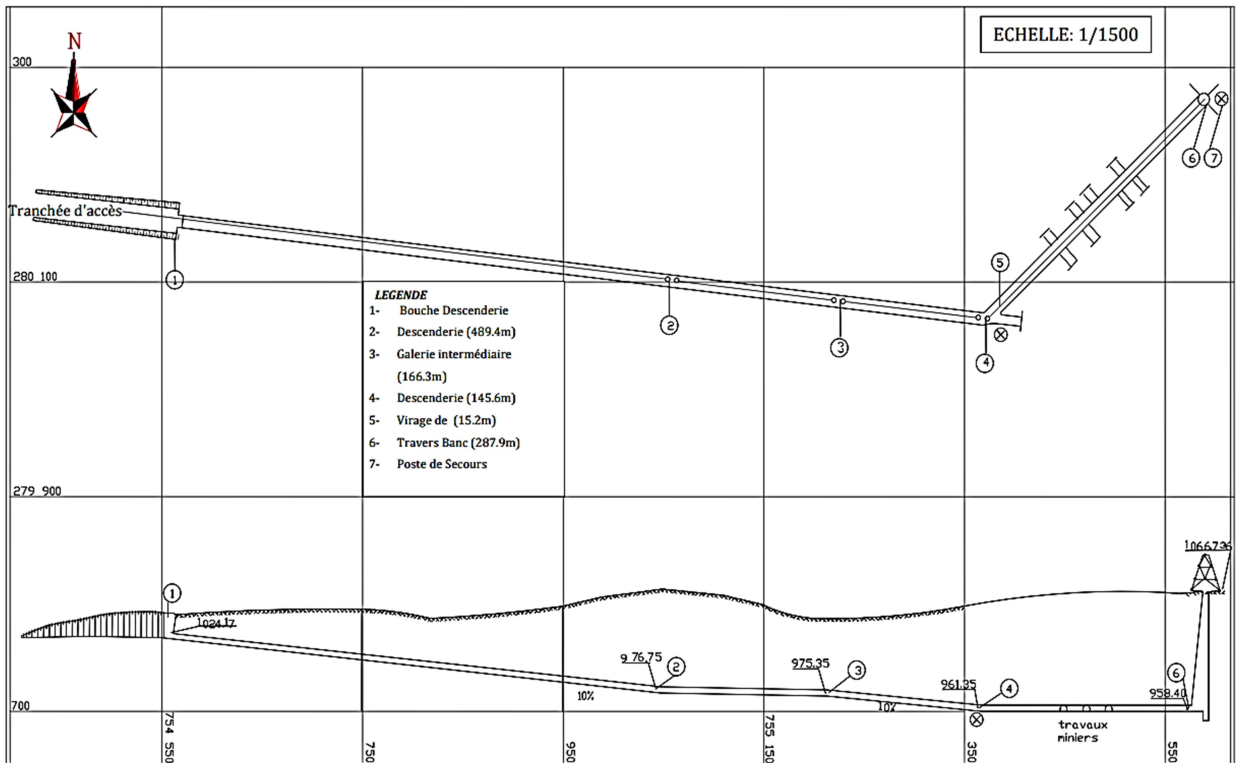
Plan et coupe des travaux d'ouvertures de la mine de Chaâbet El-Hamra (1221.4m) (d'après l'ENOF)
